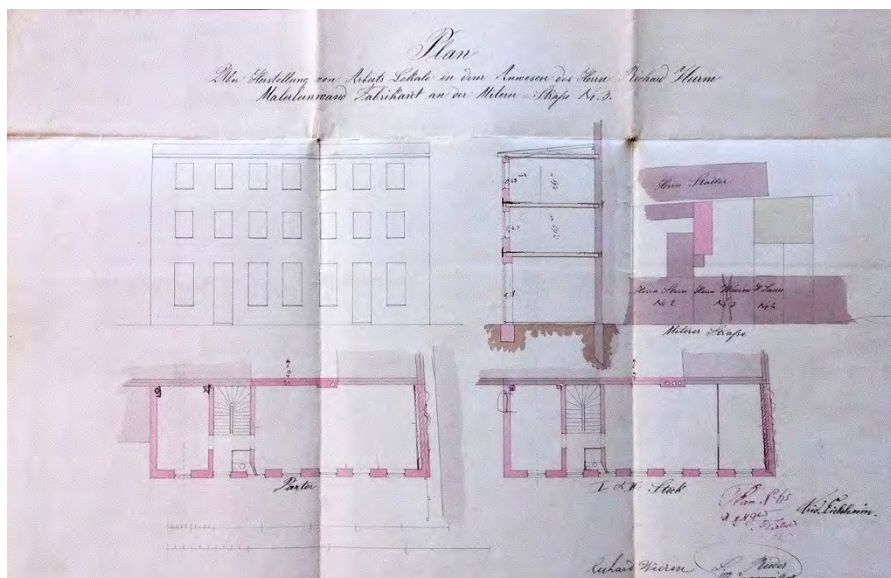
Plan zum Anbau eines dreistöckigen Fabrikgebäudes („Arbeitslokals“) durch R. Wurm, Mittererstr. 3, 1873
